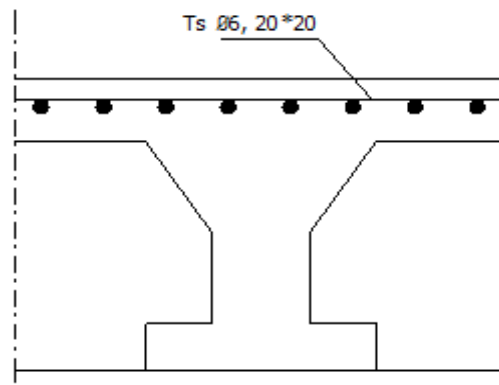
Schéma de ferrailage de la dalle de compression.
